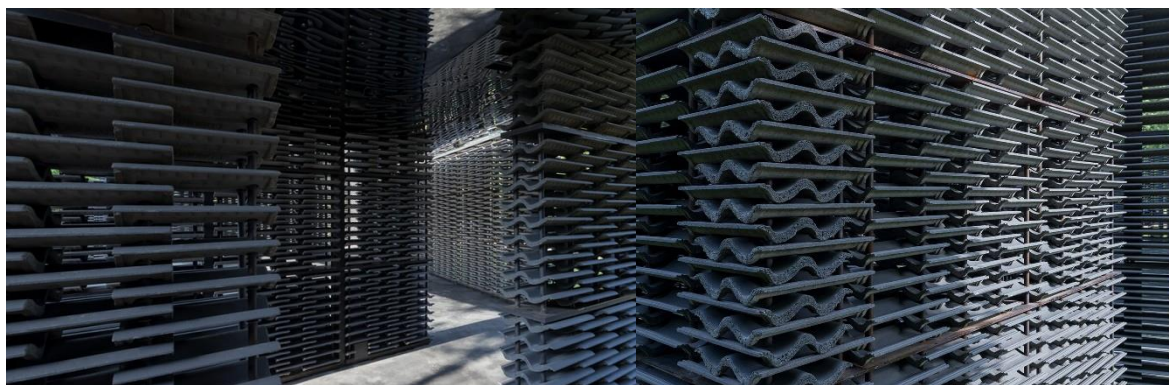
Módulos sujetos con estructura interna y plancha de unión metálica. ⁽²⁹⁾
